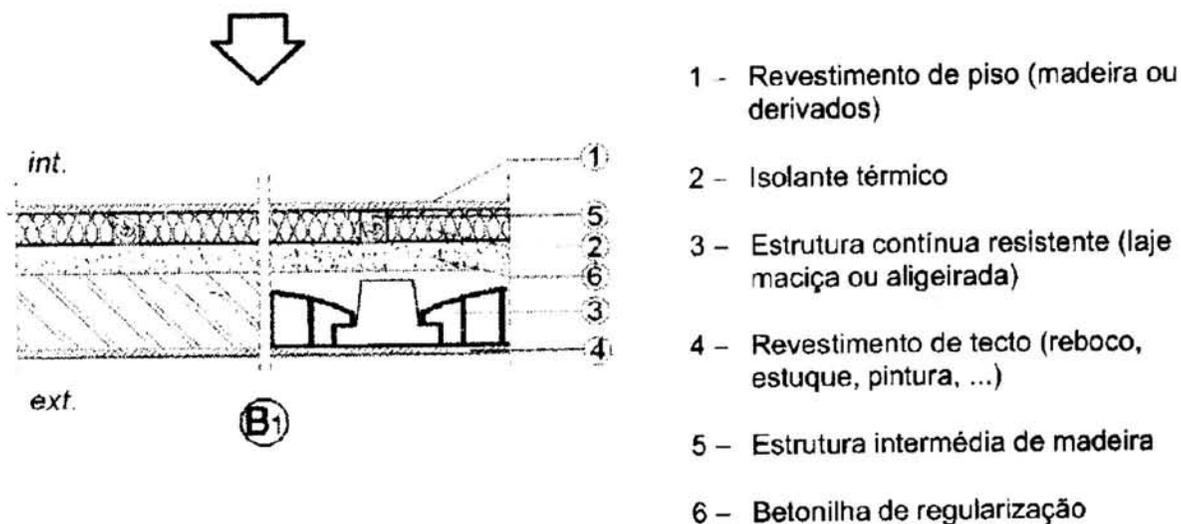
PAVIMENTO SOBRE ESPAÇO NÃO ÚTIL
